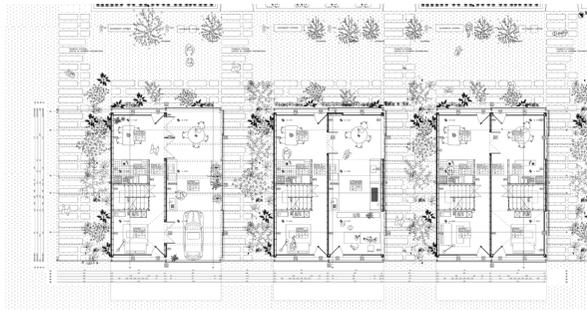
Planta baja, tres tipologías. Fuente: elaboración propia.
